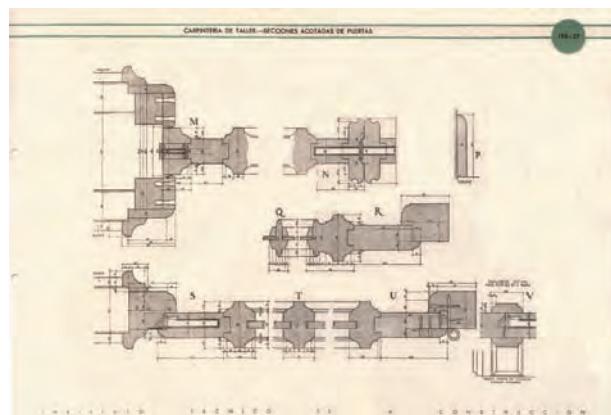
Detalles constructivos. Carpintería de taller. Puertas interiores./ *Construction detailing. Shop joinery. Doors for interiors.
